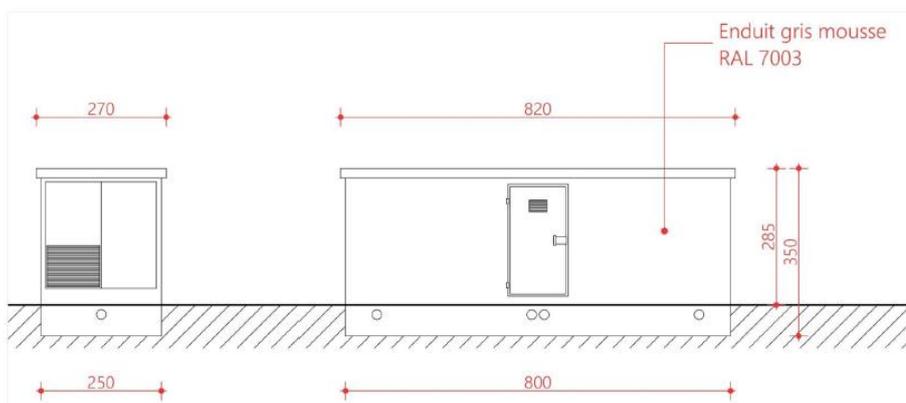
Plan de façade d'un poste électrique (Source : Atelier Nicolas Marcou)
